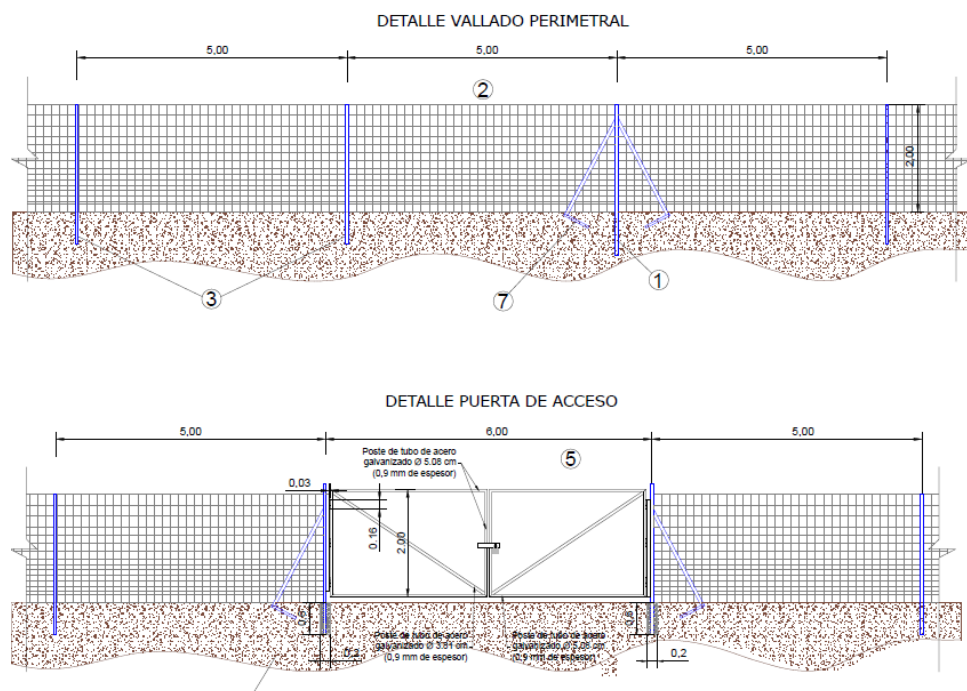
Detalle del vallado perimetral y de la puerta de acceso.
